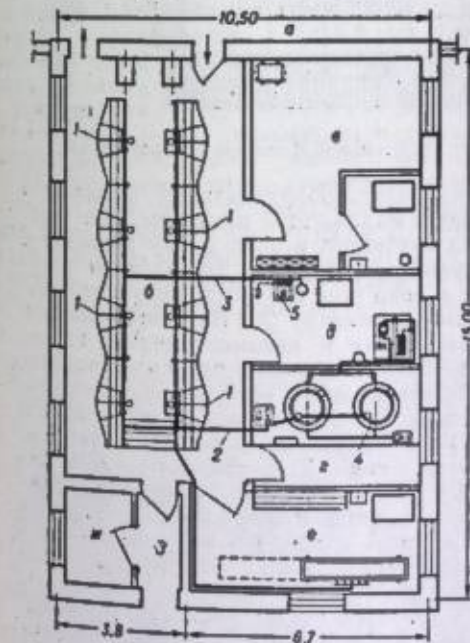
Доильная площадка типа «тандем» на 8 станков (план): а — преддольная площадка; б — доильная площадка; в — комната для персонала с лабораторией; г — молокопровод; д — вакуум-насосная; е — моечная; ж — помещение для концентратов; з — тамбур; 1 — доильные станки; 2 — молокопровод; 3 — охлаждающая установка; 4 — вакуум-насос.
